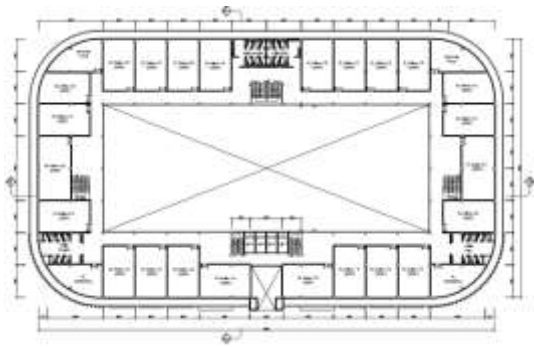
Siteplan Islamic Boarding School di Kab. Semarang
